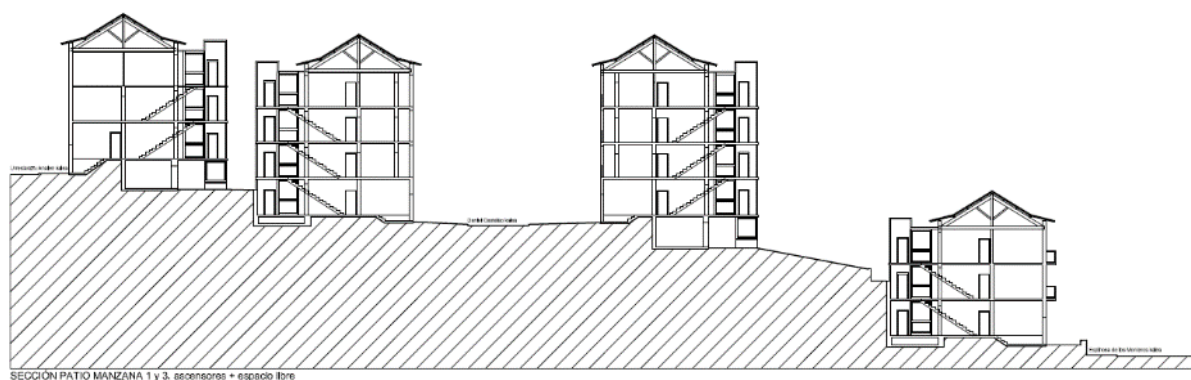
Secciones generales de los bloques residenciales ubicados en Poblado, tras la ejecución del Plan Especial. Fuente: Plano PRO.08-2 del Plan Especial.
